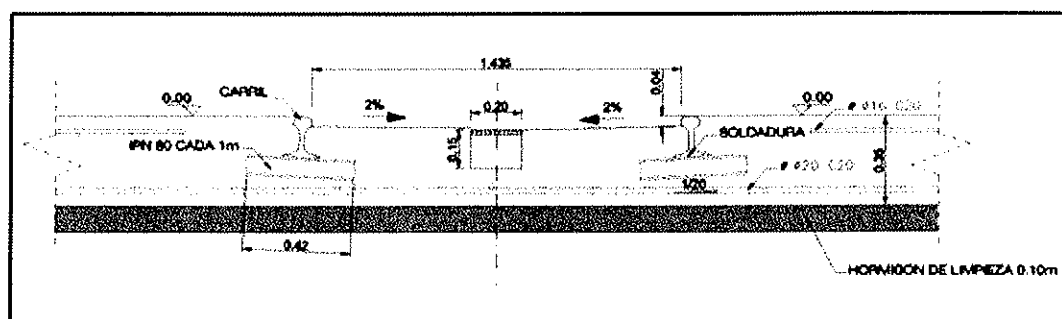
Vía con el riel enrasado con la solera en la zona exterior
